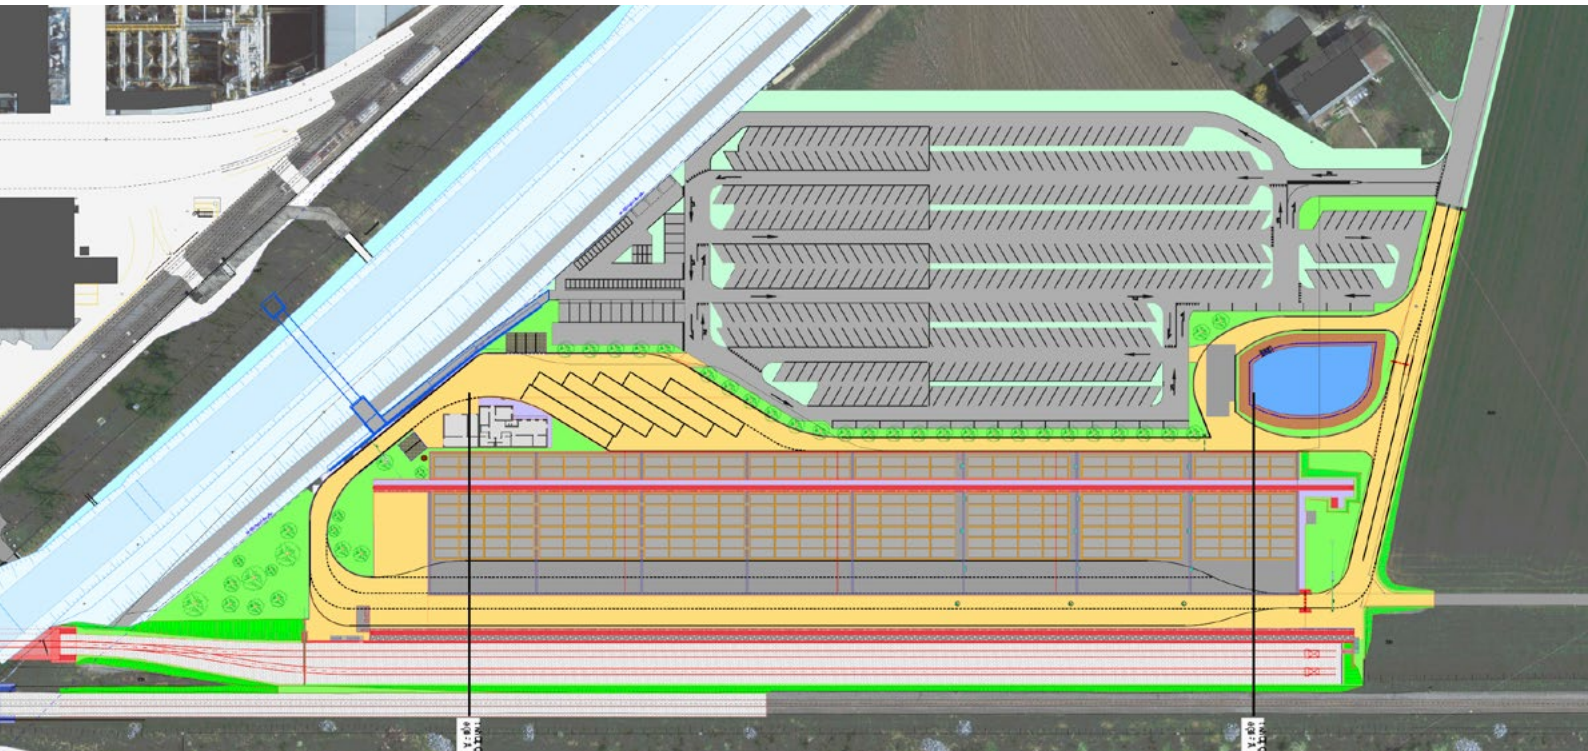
plan du Terminal et du nouveau parking Sud du site chimique
